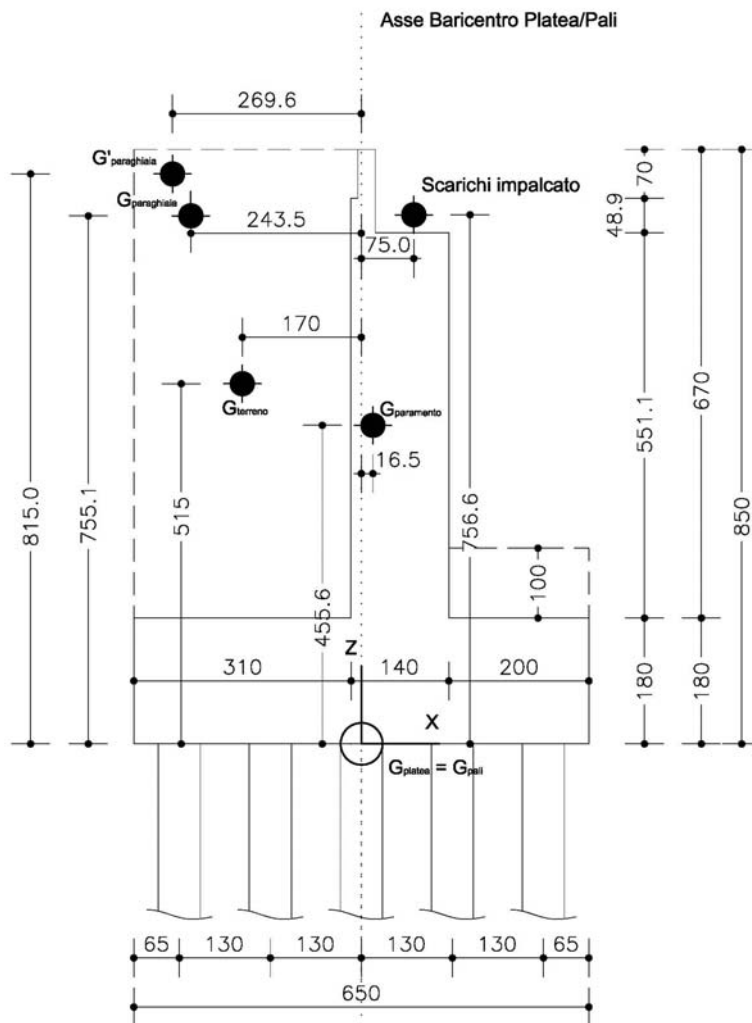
Geometria di calcolo delle spalle nello stato di fatto
